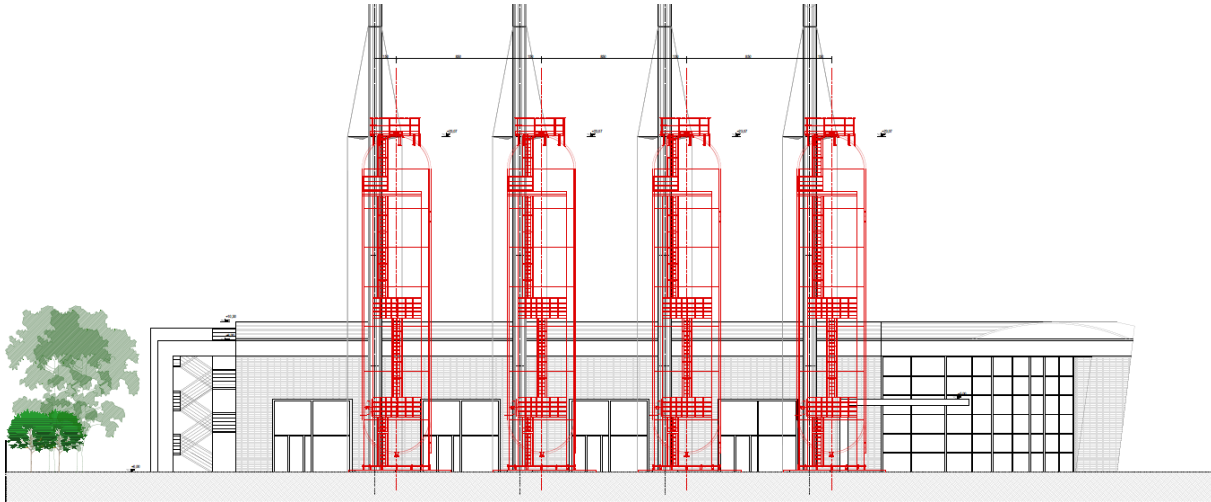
Nuovo Sistema di Accumulo, Prospetto Est (in grigio gli edifici esistenti non oggetto di intervento)
